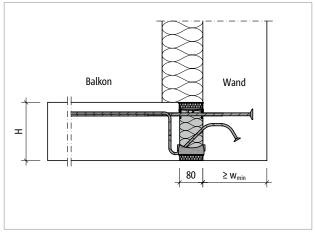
Schöck Isokorb® T Typ KL-U: Anschluss am Wandfuß bei Außendämmung
